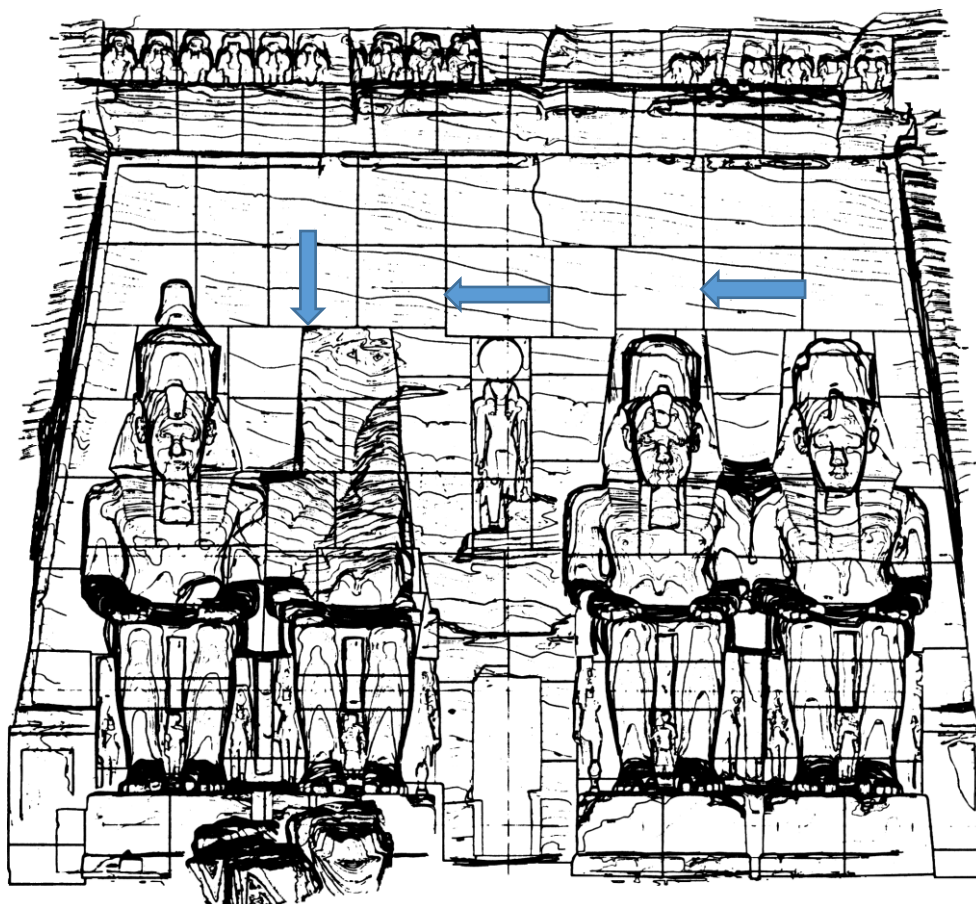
, Alzado con el despiece determinado para su posible traslado
